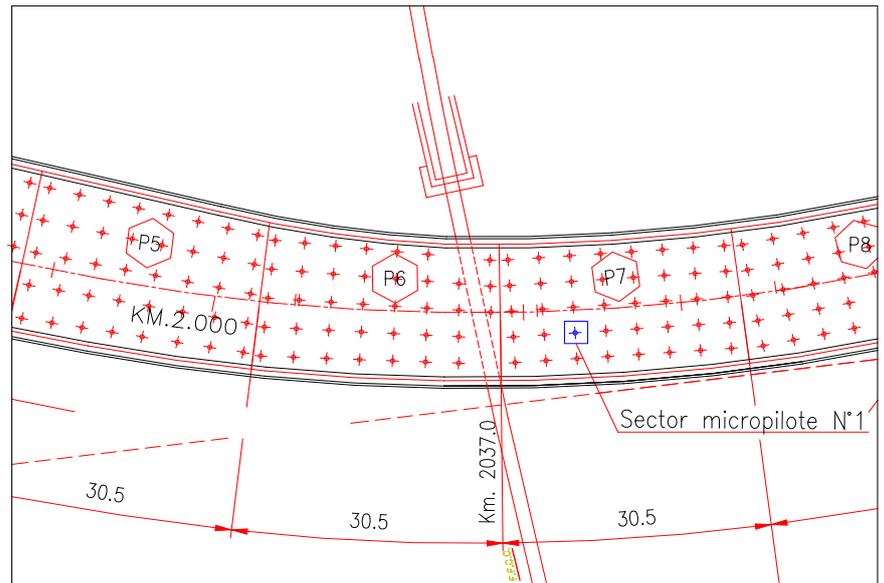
Vista en Planta de una sección de la Losa y disposición de Micropilotes
